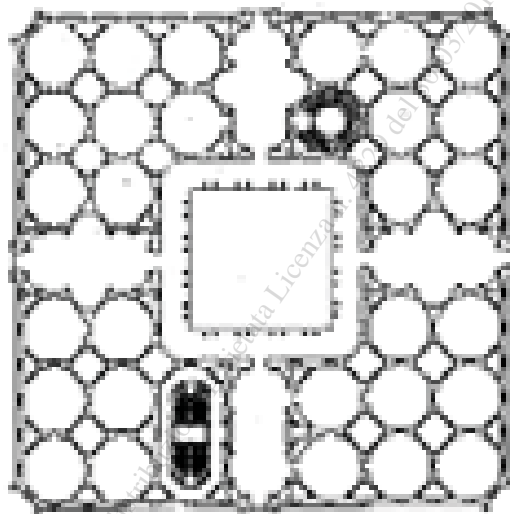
Progetto di pianta per un palazzo Barberini (?)
